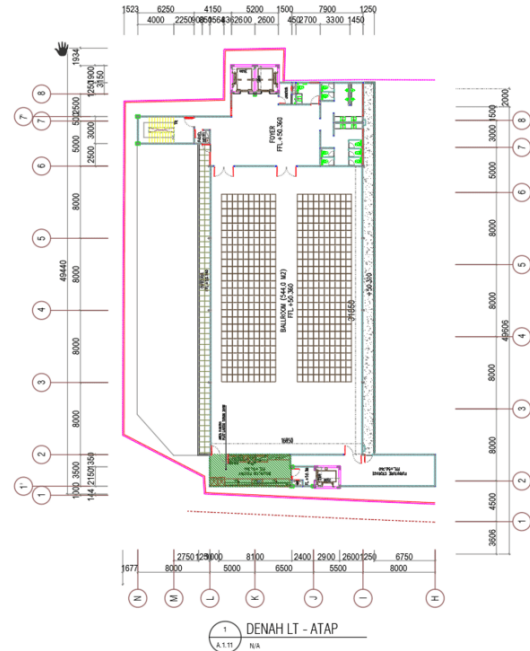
Denah Lantai 5 Gedung Hotel (PT PIBK, 2025)
